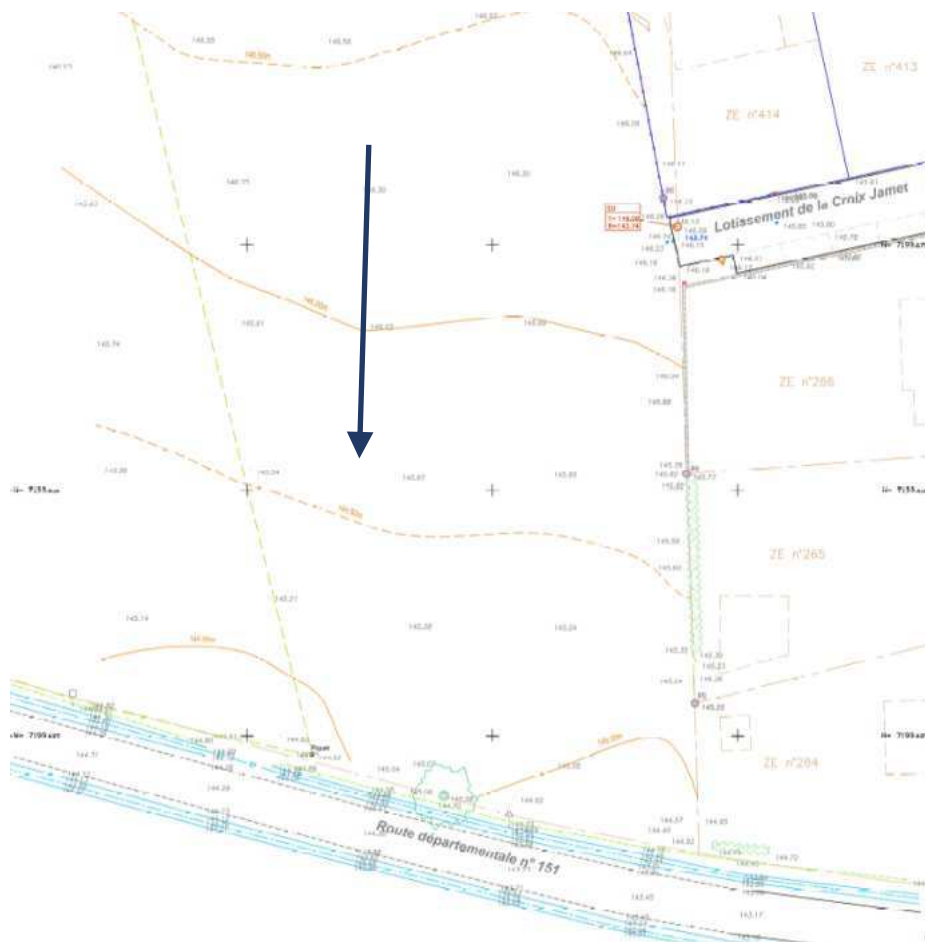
EXTRAIT DU PLAN TOPOGRAPHIQUE
